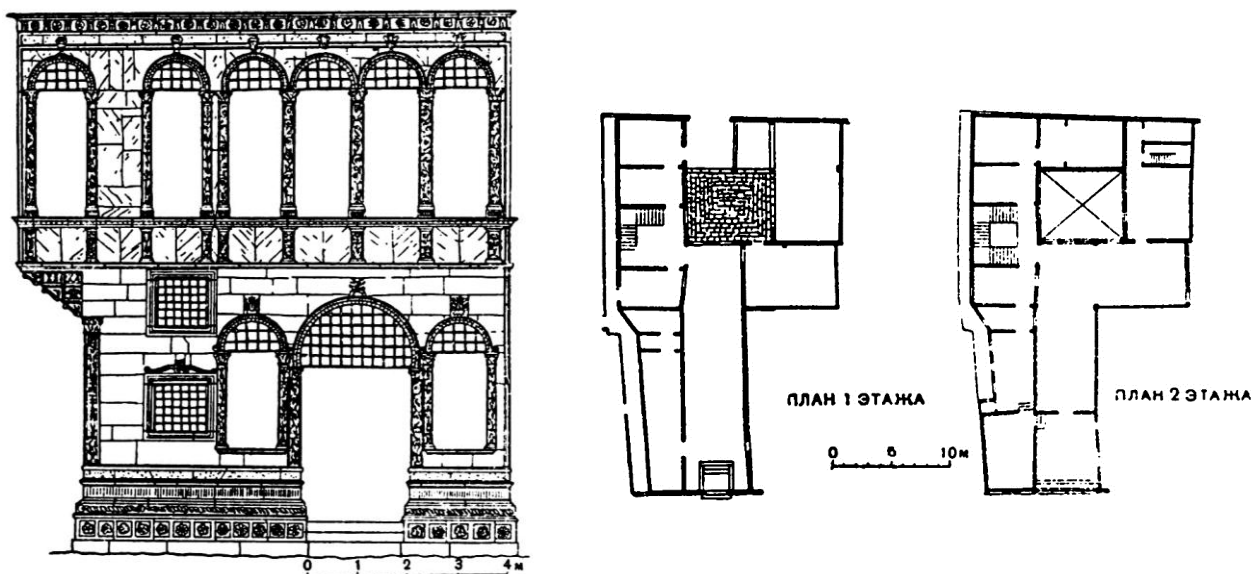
Венеция. Палацетто Гуссоли. Планы 1-го и 2-го этажей. Фасад
